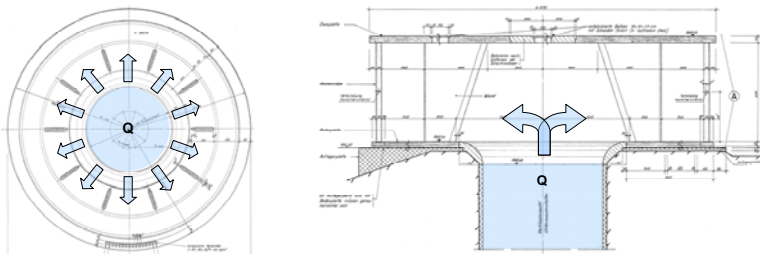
Grundriss und Aufriss des Ein-/Auslaufbauwerkes im Grimselsee
